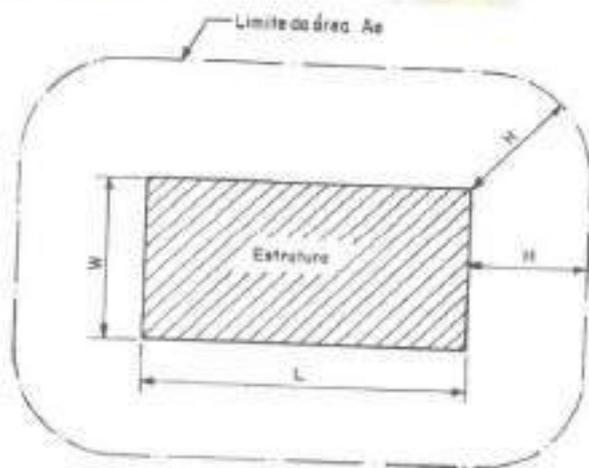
Delimitação da área de exposição equivalente (Ae) - Estrutura vista de planta
